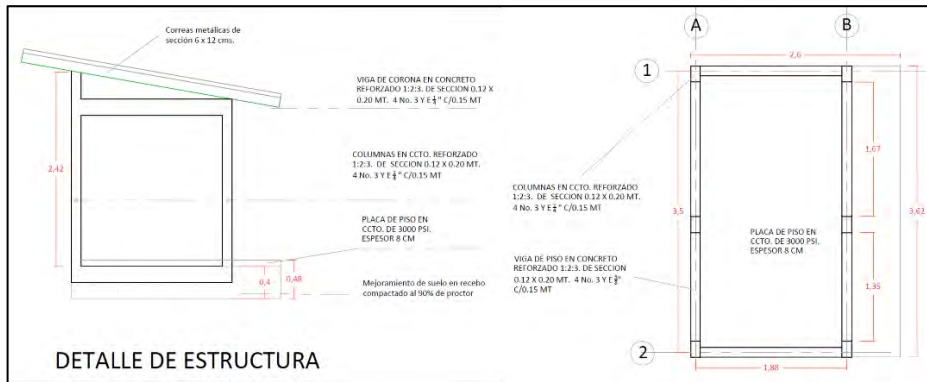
Detalle de la estructura de la caseta de vigilancia
